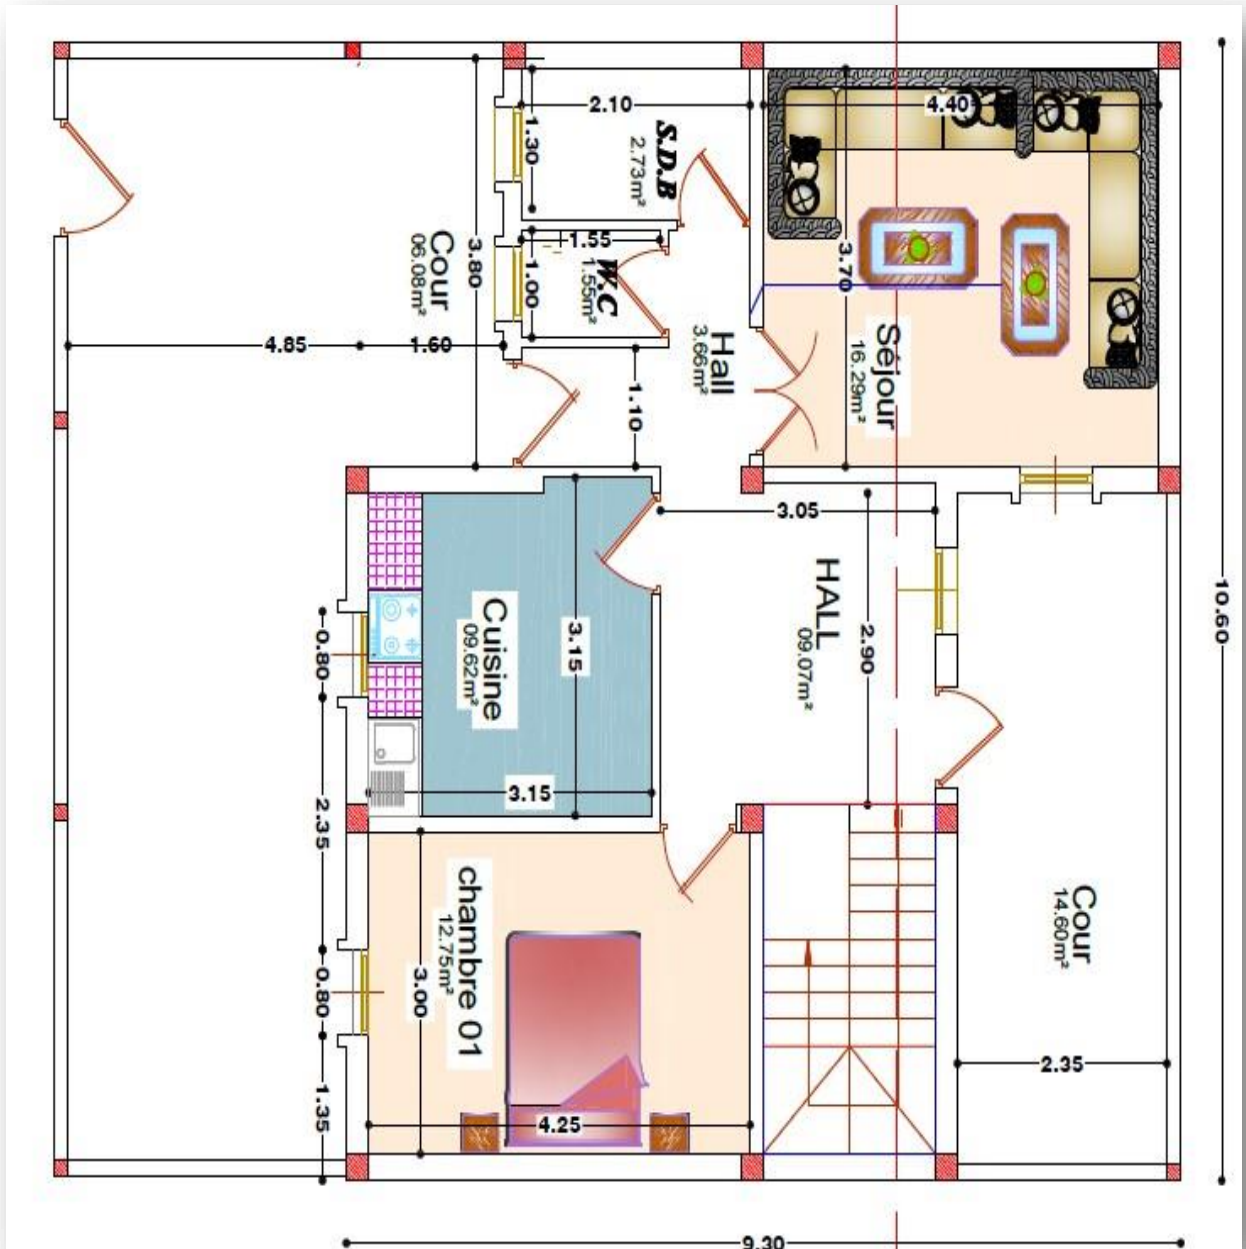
Plan architectural de maison (RDC). (Bureau d'études Andalousie, 2024)
